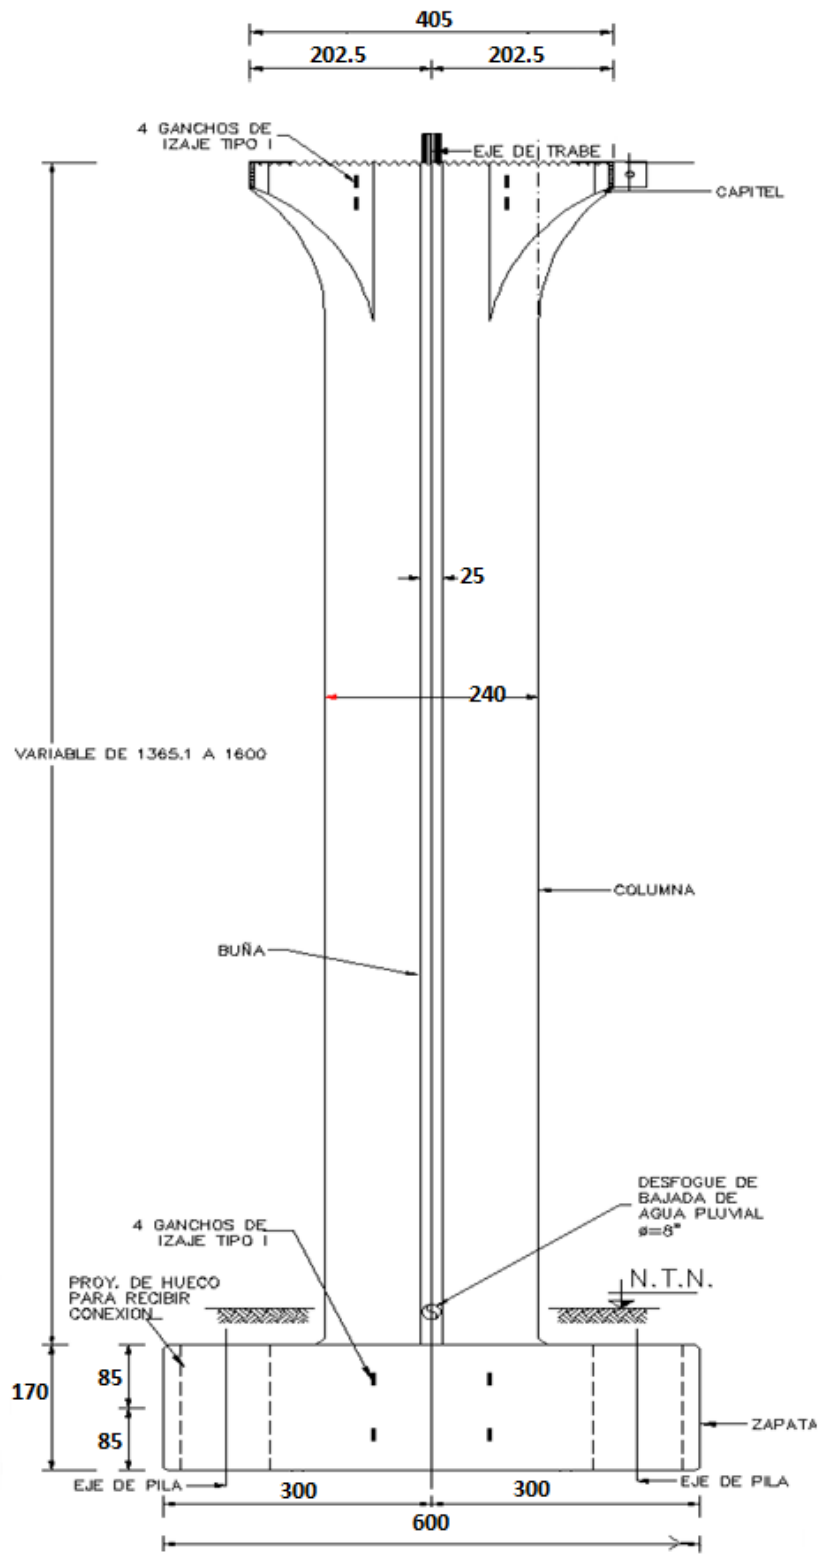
Geometría de Zapata-Columna - Sección transversal.
